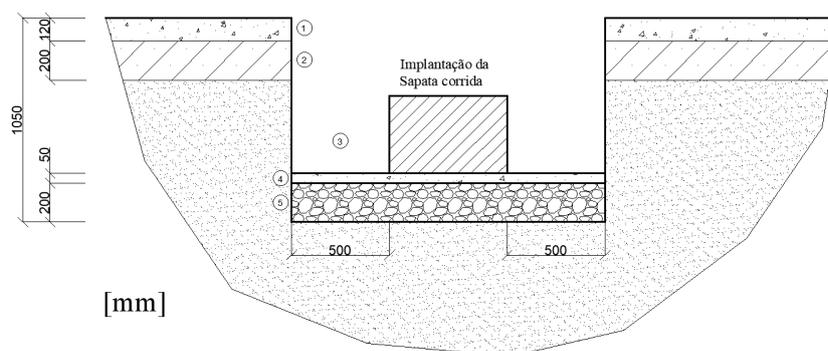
Representação de um corte transversal da escavação local da zona da sapata
